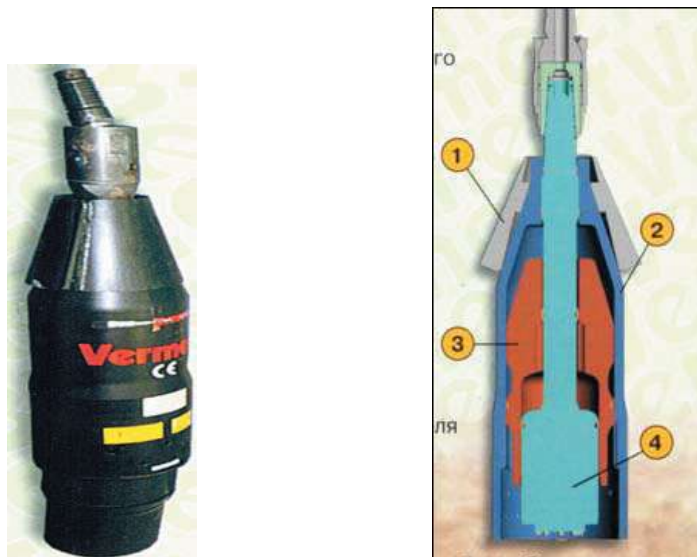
Пневматичне устаткування ІМПАСТОР: а – загальний вигляд; б – розріз (1 – набір лопаток; 2 – корпус; 3 – ударник; 4 – розширювач)
